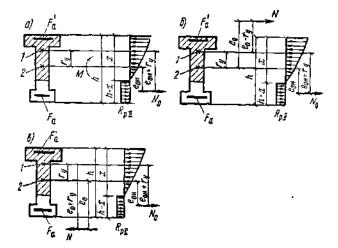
Схемы усилий и эпюры напряжений в поперечном сечении элемента при расчете его по образованию трещин, нормальных к продольной оси элемента, в зоне сечения, растянутой от действия внешних нагрузок
